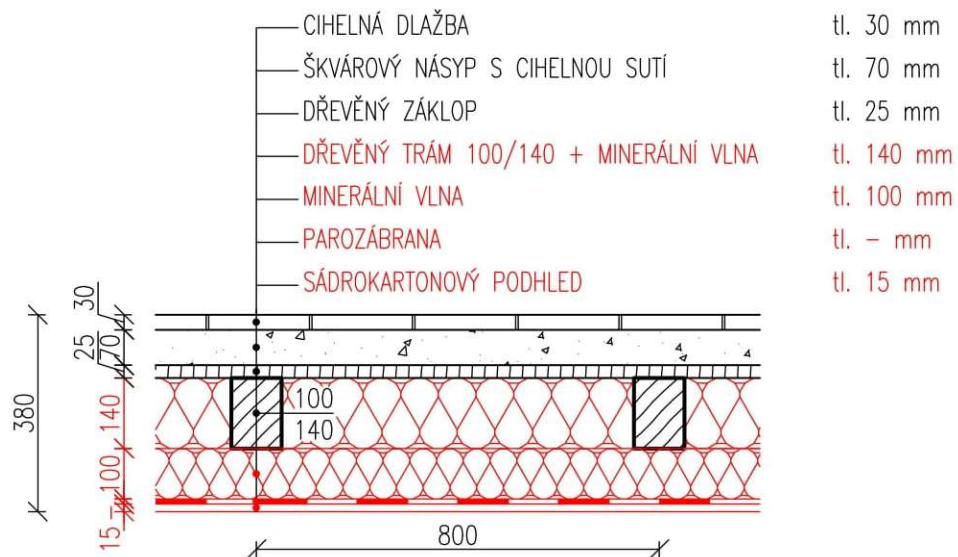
Zateplení stropní konstrukce 1. NP – varianta 1
